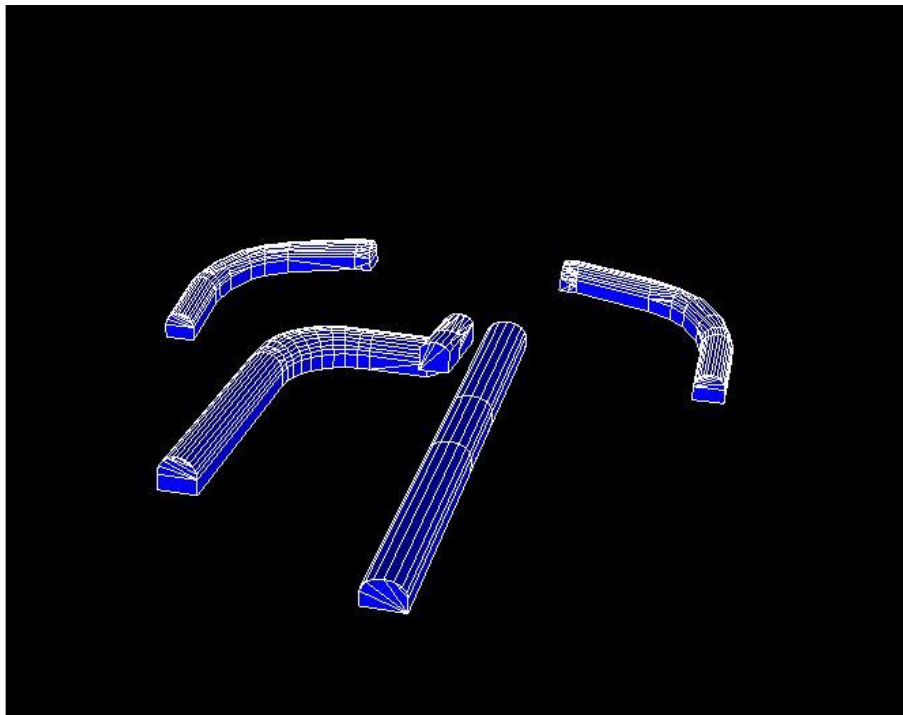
Etapa N°4, Galería de Acceso Constructivo
